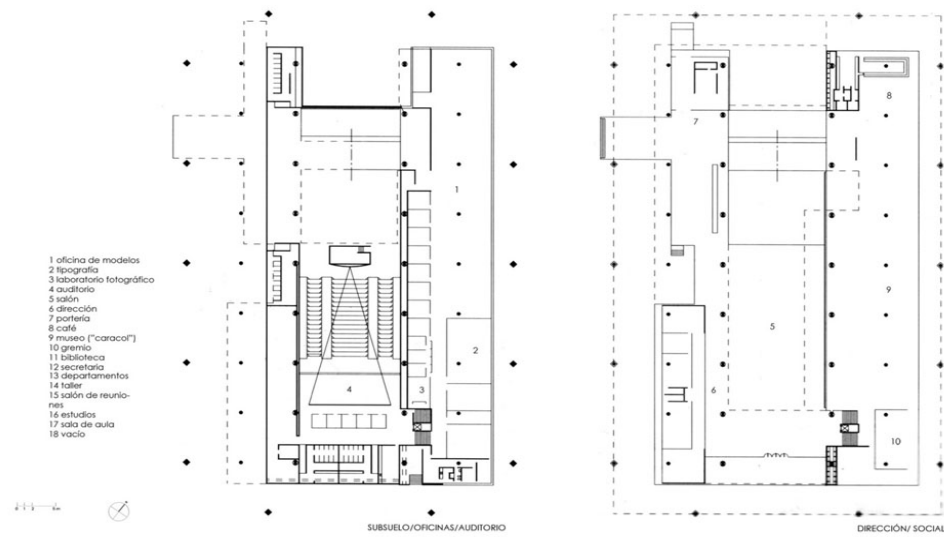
Planta Baixa da FAU-USP. Fonte: Plataforma Arquitectura.
